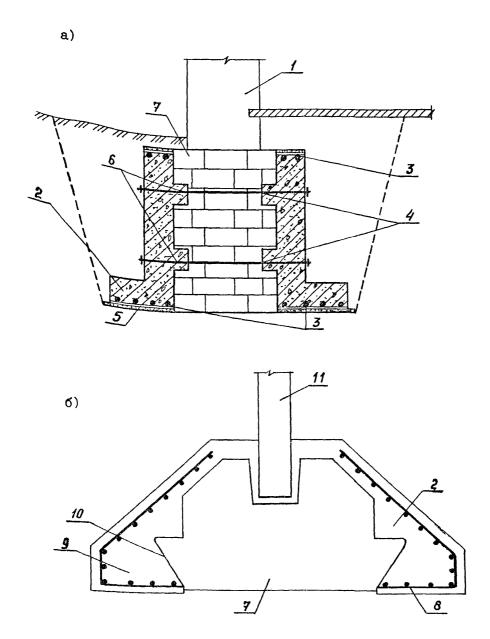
Усиление кирпичного или бетонного фукндамента
